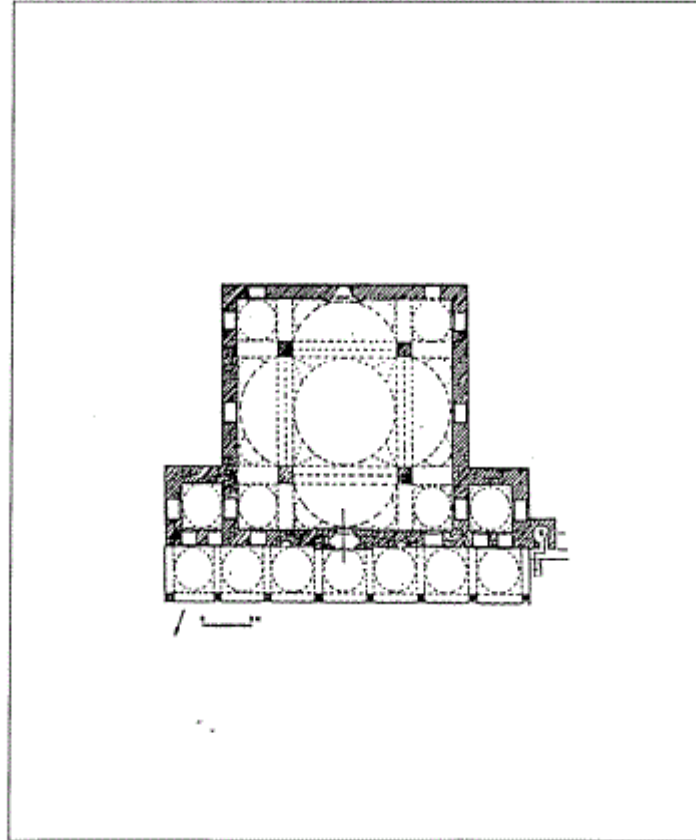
مسقط أفقي لمسجد چلبي سلطان محمد في ديوتيقا (عن : اصلان ابا)
